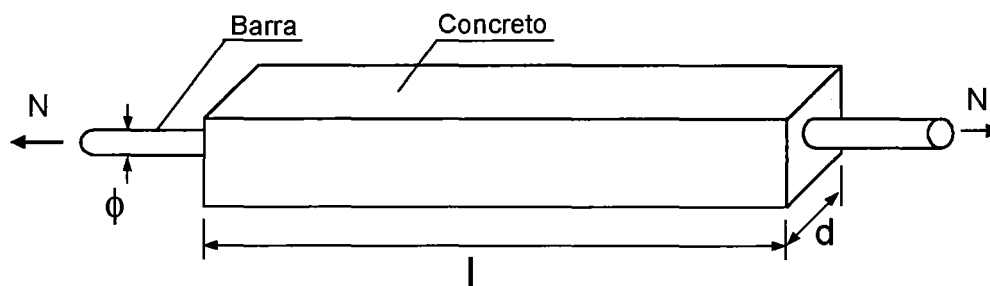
Corpo de prova para determinação da aderência concreto/aço.
